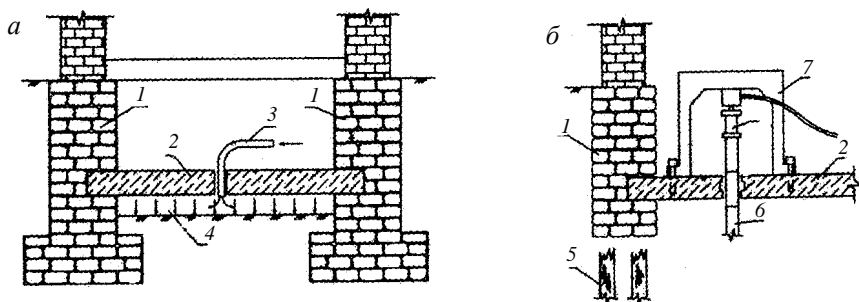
Увеличение опорной площадки с помощью монолитной железобетонной плиты:
